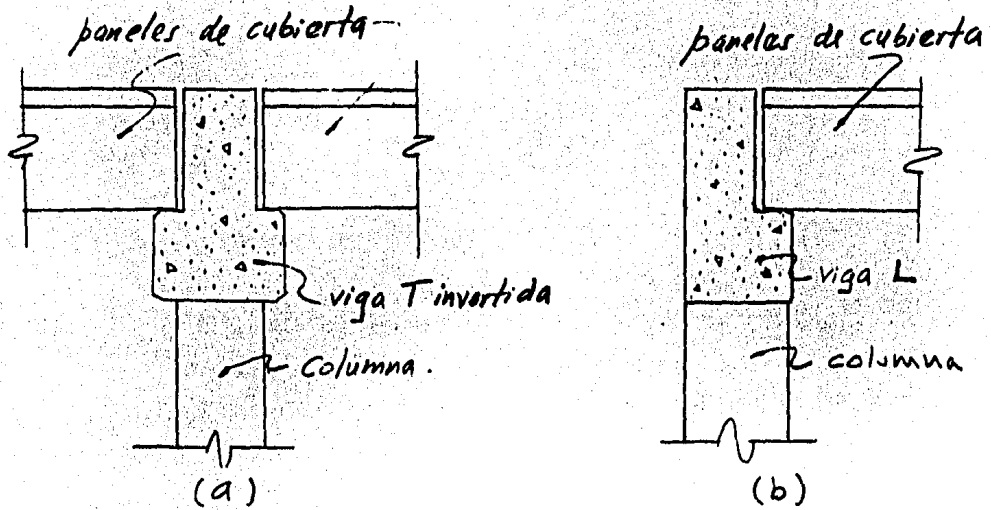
Secciones de vigas (a) T invertida y (b) sección L.
